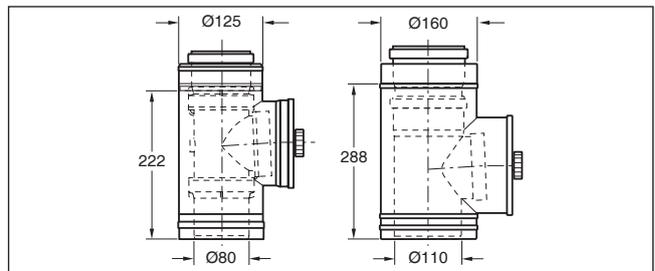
Konzentrisches Rohr mit Prüföffnung aus Edelstahl (Maße in mm)
